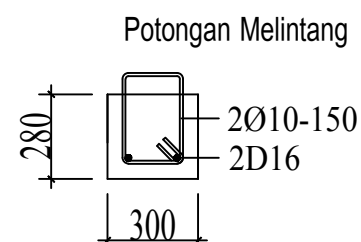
DETAIL BALOK ANAK TIPE BA2 SETELAH KOMPOSIT
